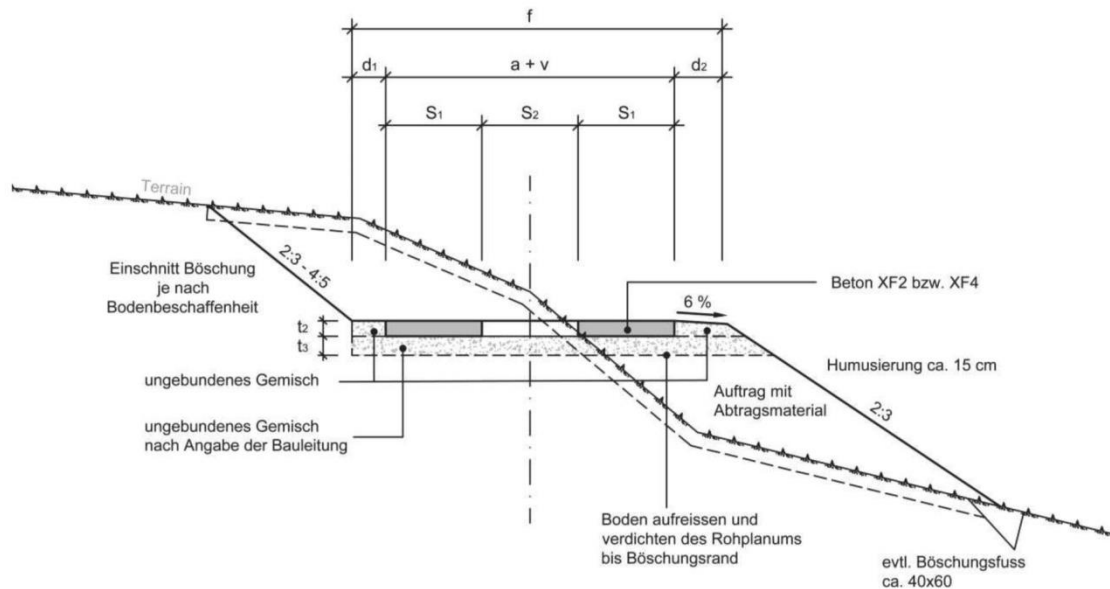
Starrer Oberbau mit Betonspuren – Einschnitt und Auffüllung (ohne Entwässerung).
